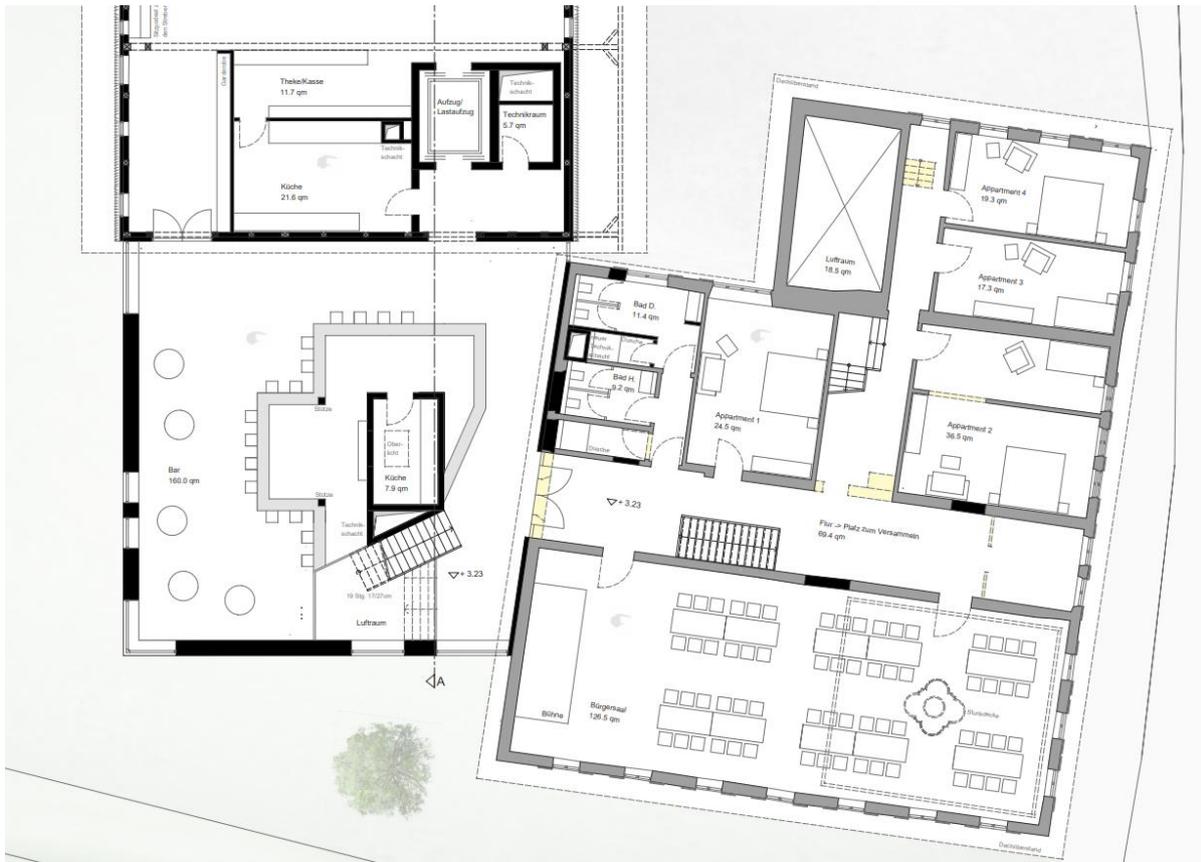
neuer Grundriss Obergeschoss Gasthaus
